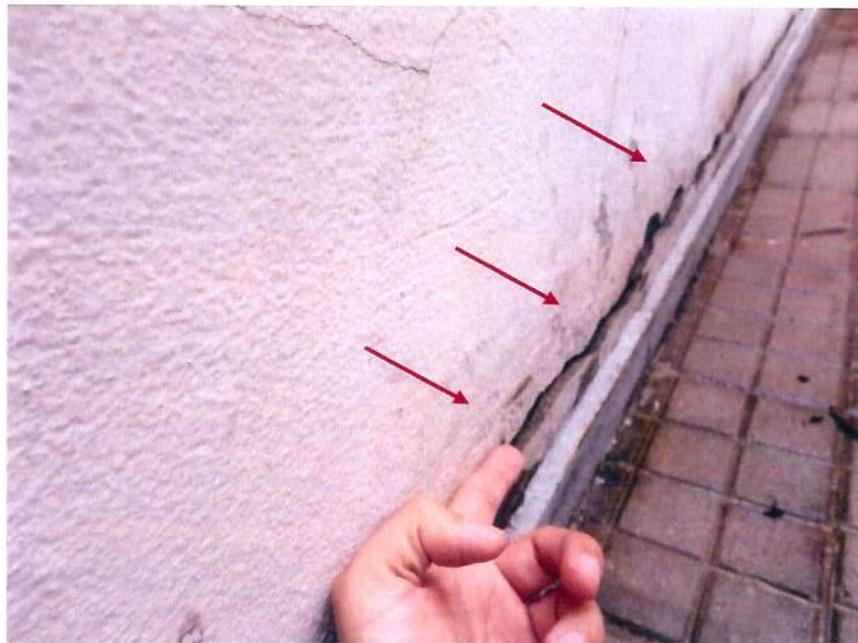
Detalhe de fissura sendo indício de movimentações da estrutura.
